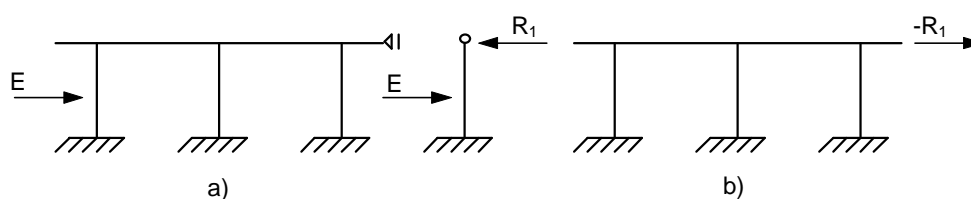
Distribuição do empuxo de terra (E) entre os pilares. Esquema admitindo o tabuleiro apoiado horizontalmente (a); aplicação da reação R_1 na estrutura real.
